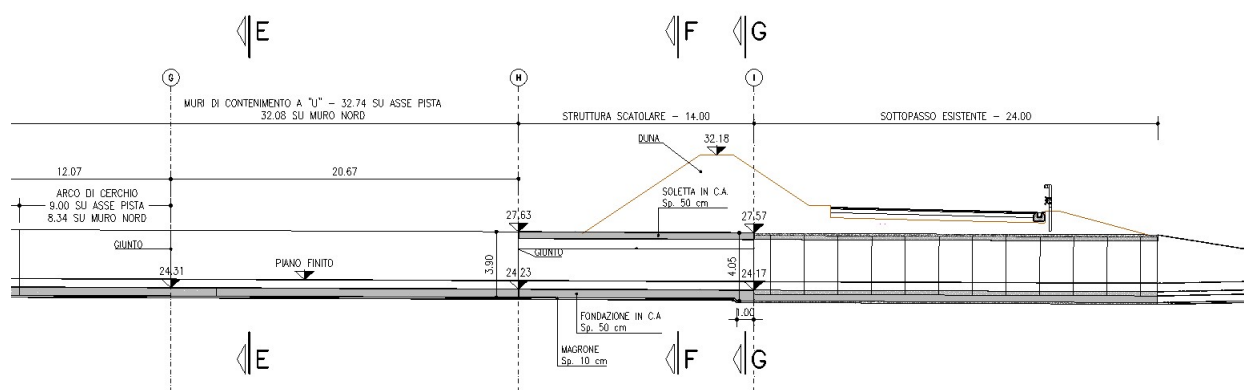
9: Sezione longitudinale dei muri ad U e sottopasso lato ovest
